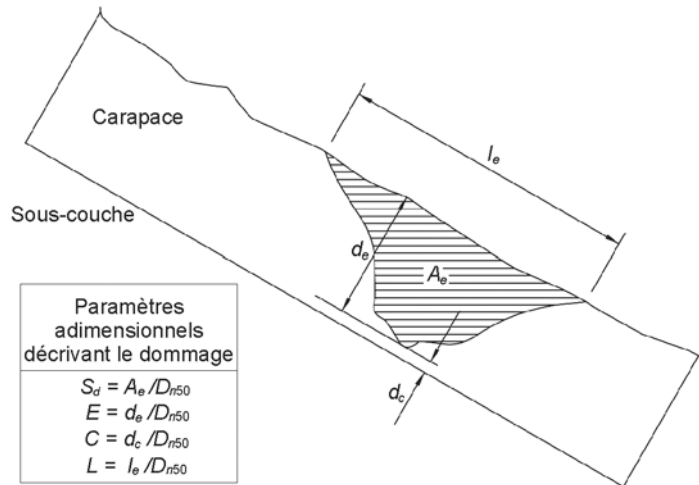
Schéma d'un profil de digue et définition des paramètres de dommage (Melby, 1999)
